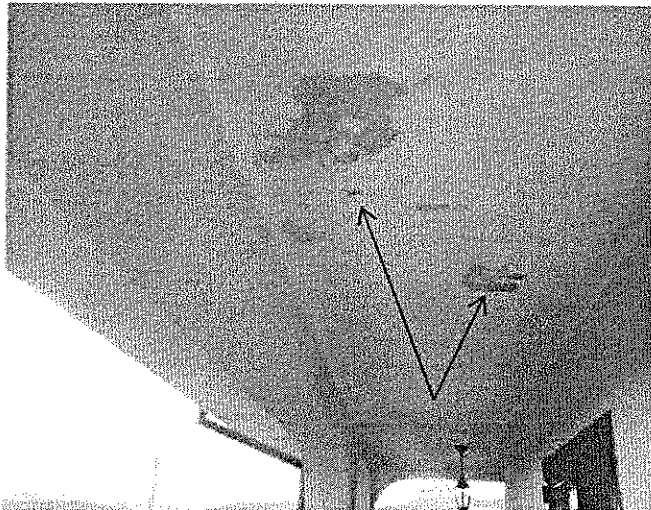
e 18 -Particolare inizio degrado di un Soffitto esterno.
